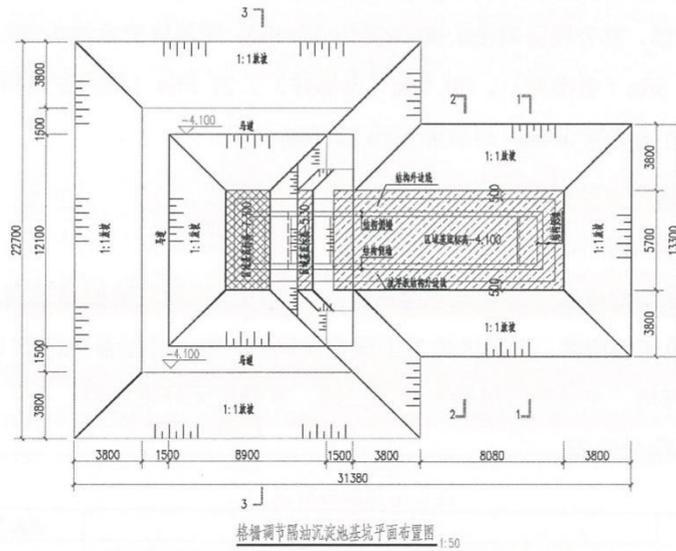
格栅调节隔油沉淀池基坑平面布置图
